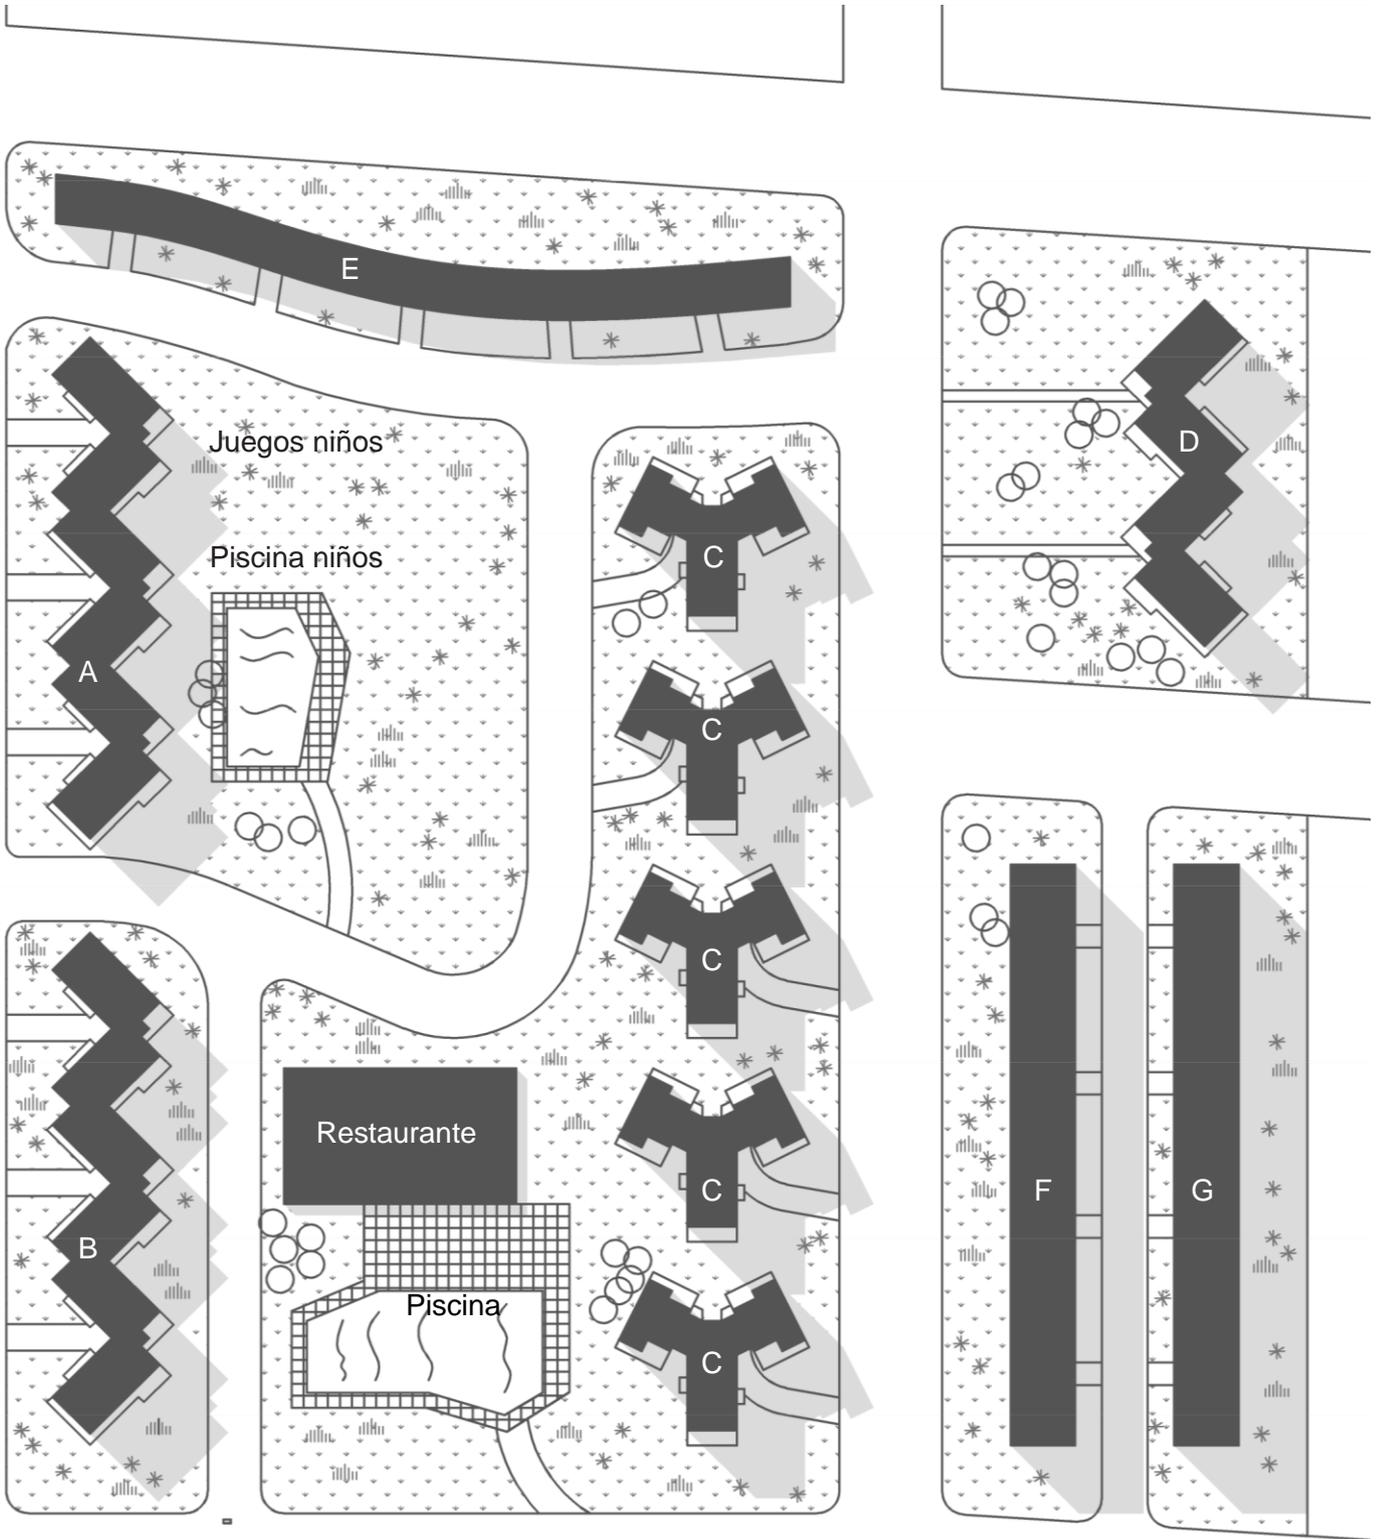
Planta del conjunto, Anteproyecto septiembre 1961. Elaboración propia.
